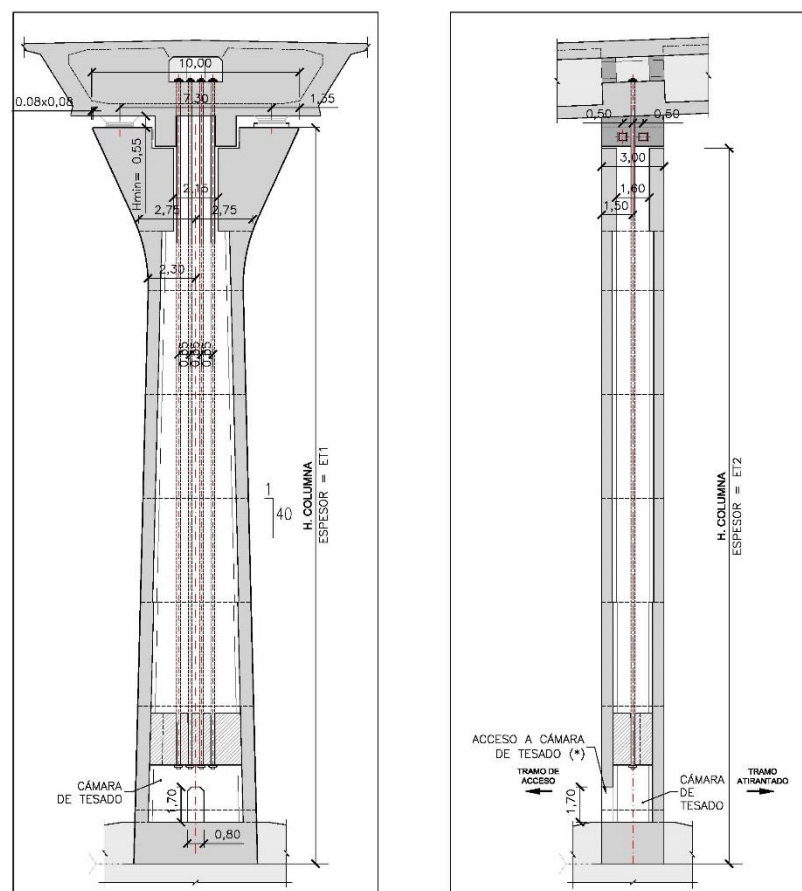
Sección transversal y longitudinal de las pilas de retenida
